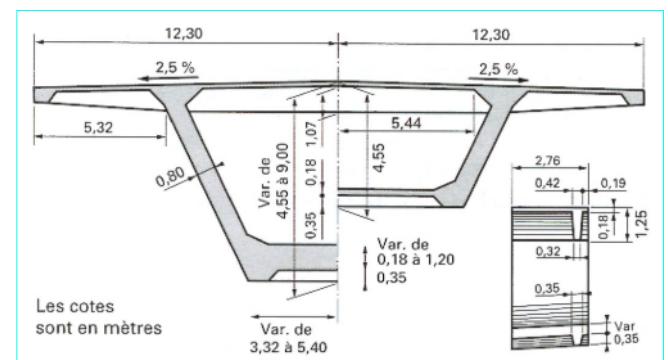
Coupe transversale du pont de Chevrié (tablier en béton)
